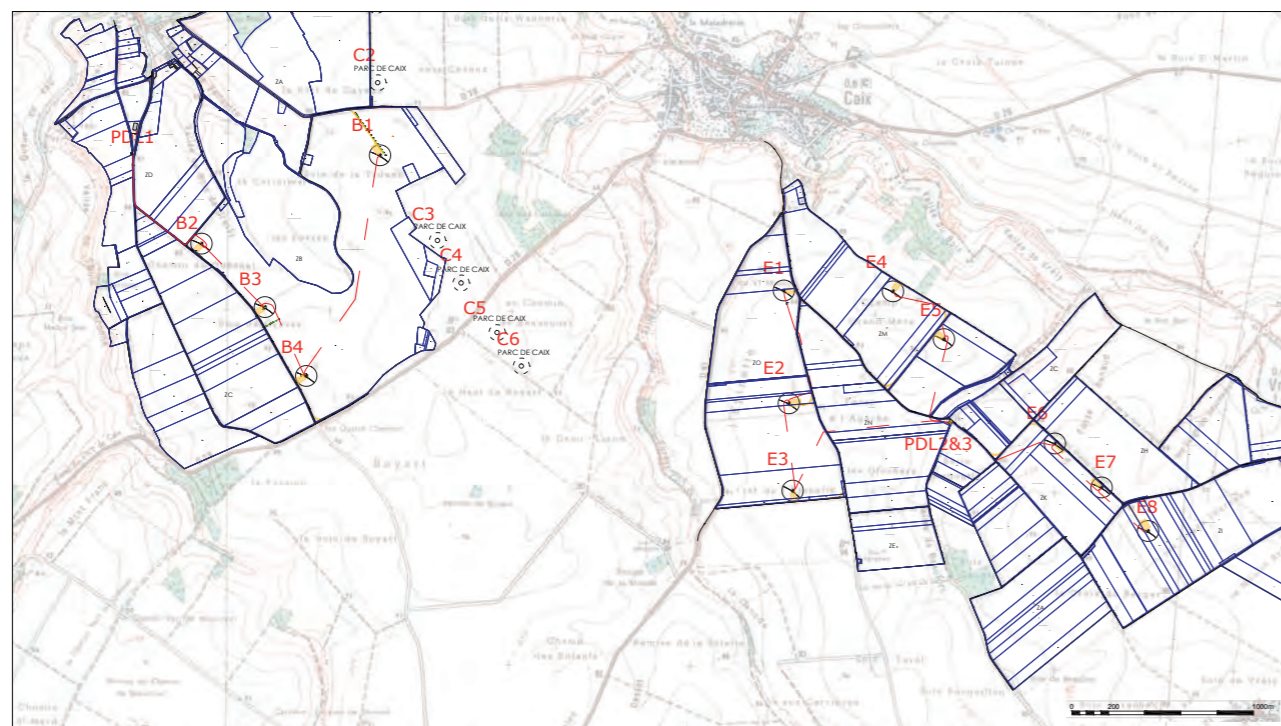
PLAN DE SITUATION DES POSTES DE LIVRAISON 1/2
